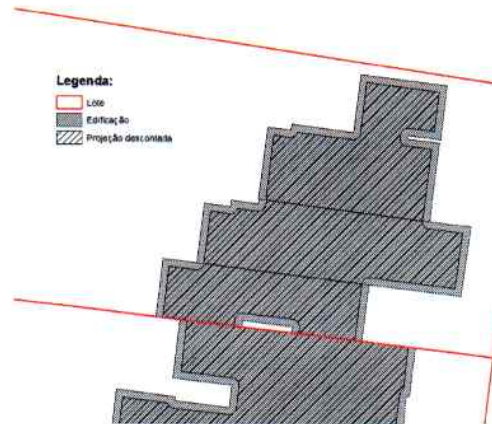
Onde a edificação toca o limite do lote, não é aplicado o desconto. Onde a Edificação toca outra edificação não é aplicado o desconto.
